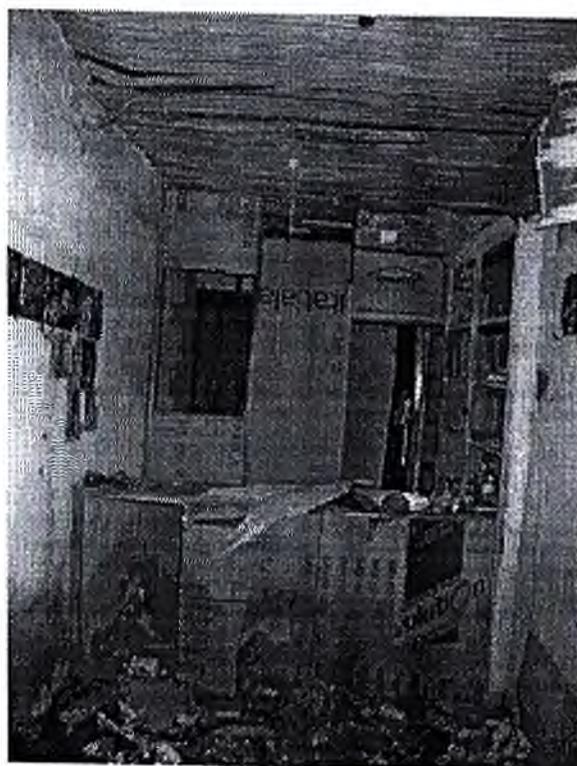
Forro em madeira deteriorado e entulho em cômodo
